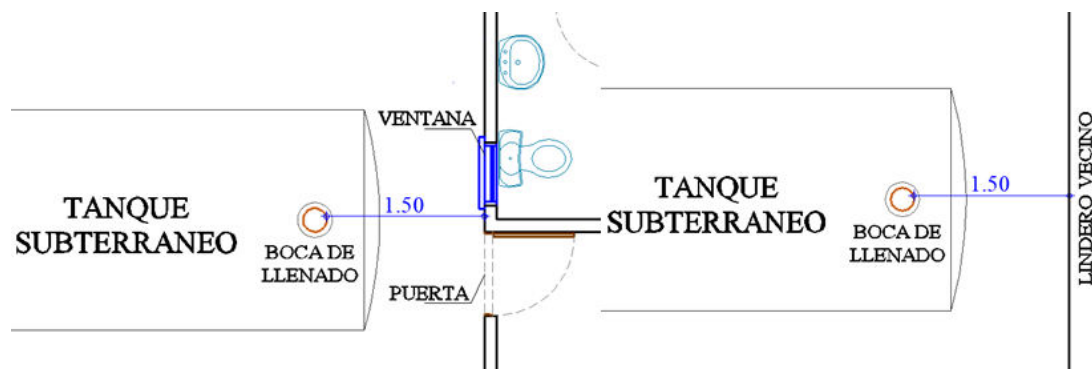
Boca de llenado de los tanques. Fuente. Autores del proyecto.
